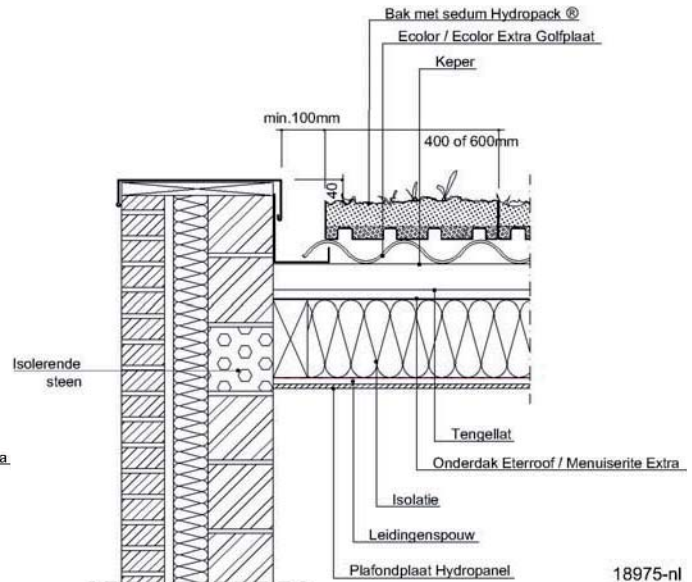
Zijrandafwerking met volledige Hydropack® Klassieke constructie met baksteen
